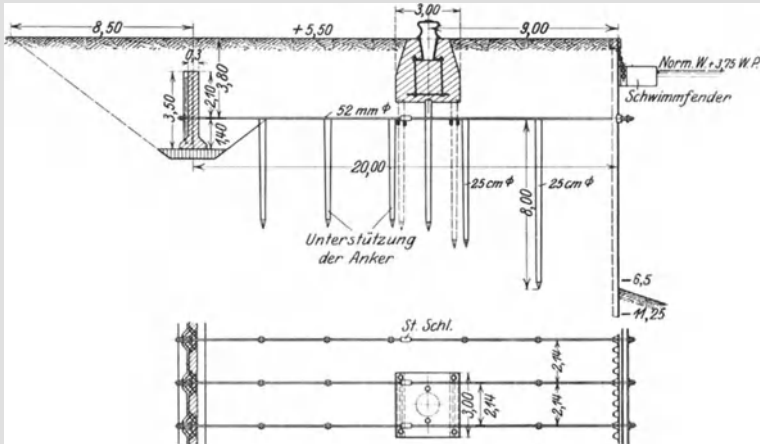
a u. b. Bollwerk im Hamburger Zwischenhafen.
